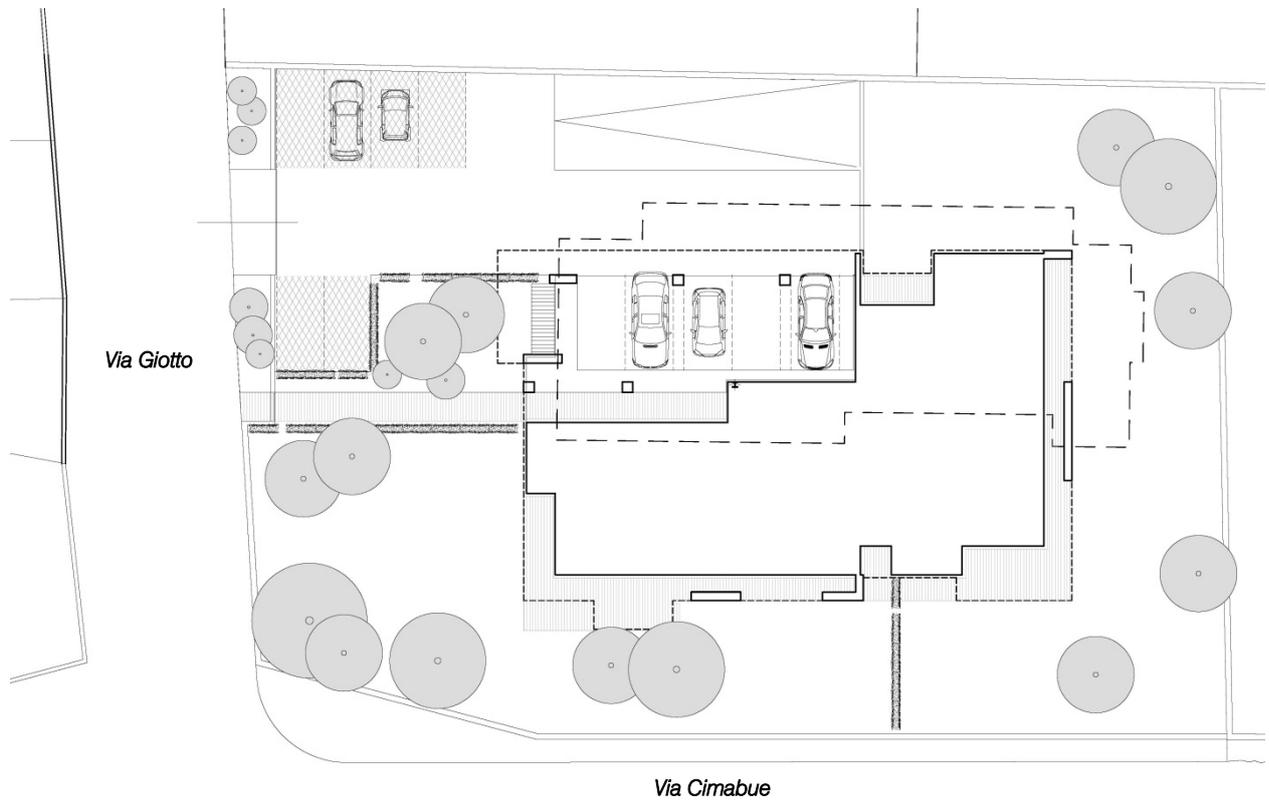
Lotto di intervento – planimetria stato di progetto
